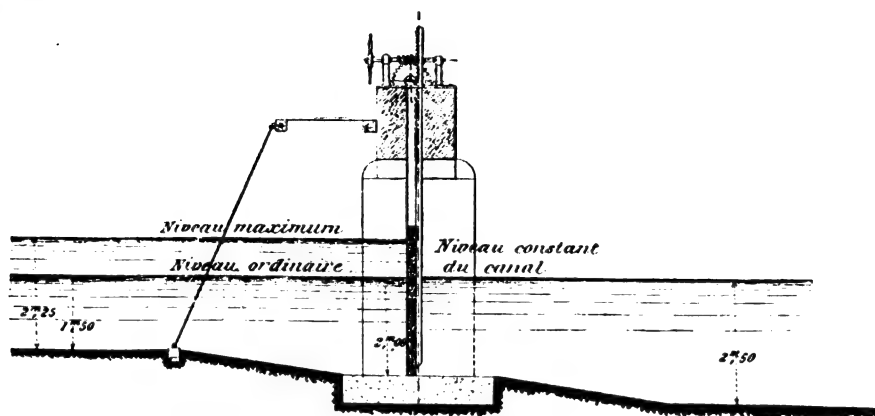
Entrée du canal de prise; coupe longitudinale.
